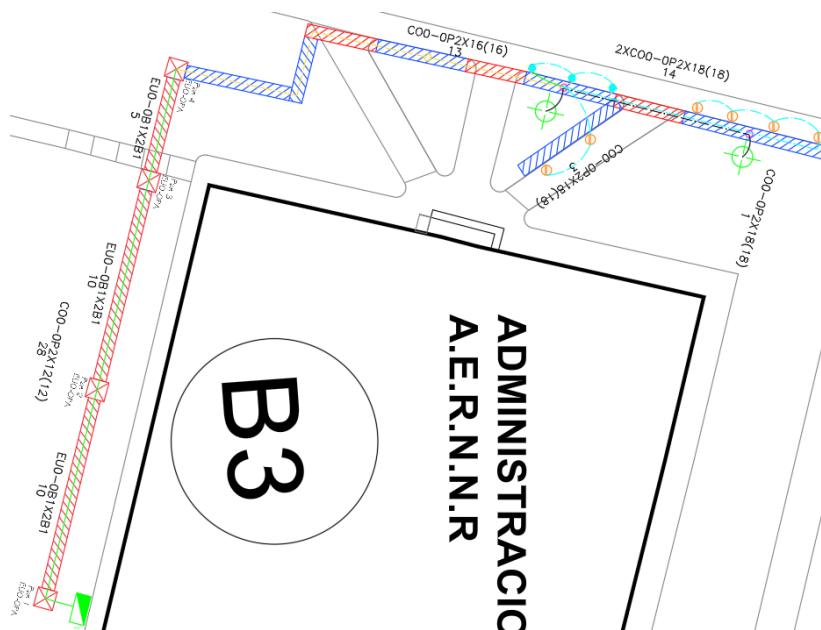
Diseño de la canalización existente y proyectada en Autocad
